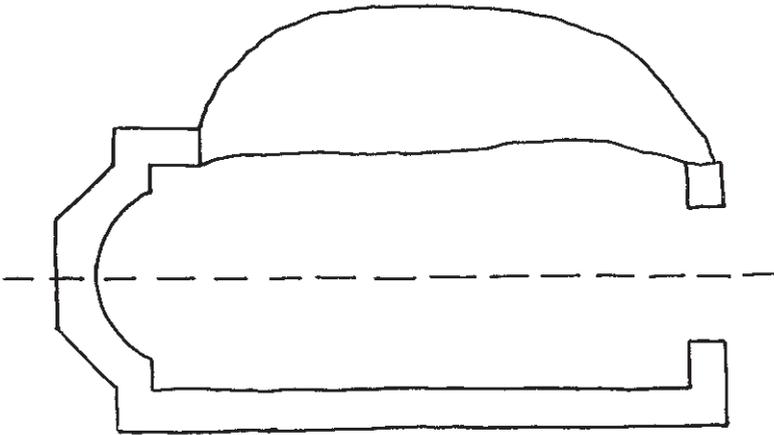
Rekonstruierter Grundriss der Kapelle
